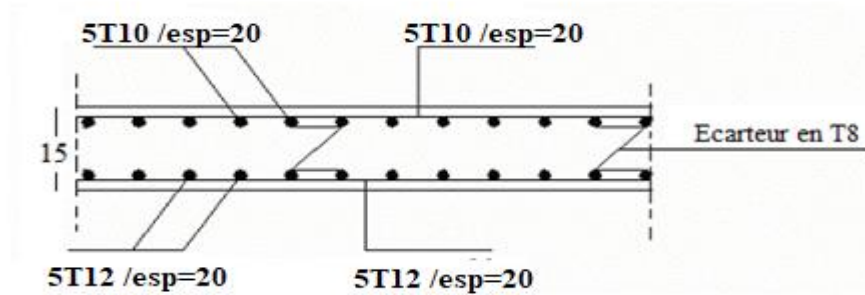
Schéma de ferrailage de la dalle pleine.
